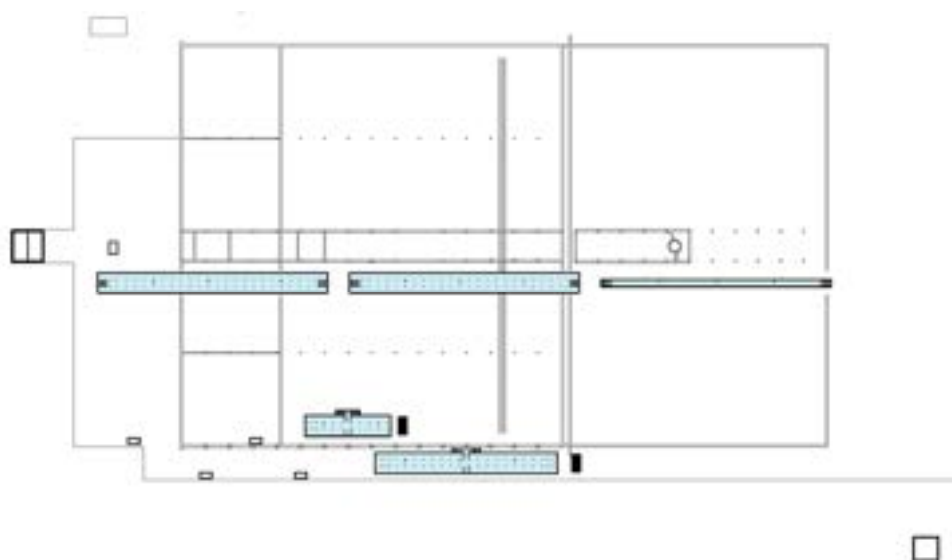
Fördelning av BTA plan 2. Ej redovisat i bild – fläktrum uppe på taket.
